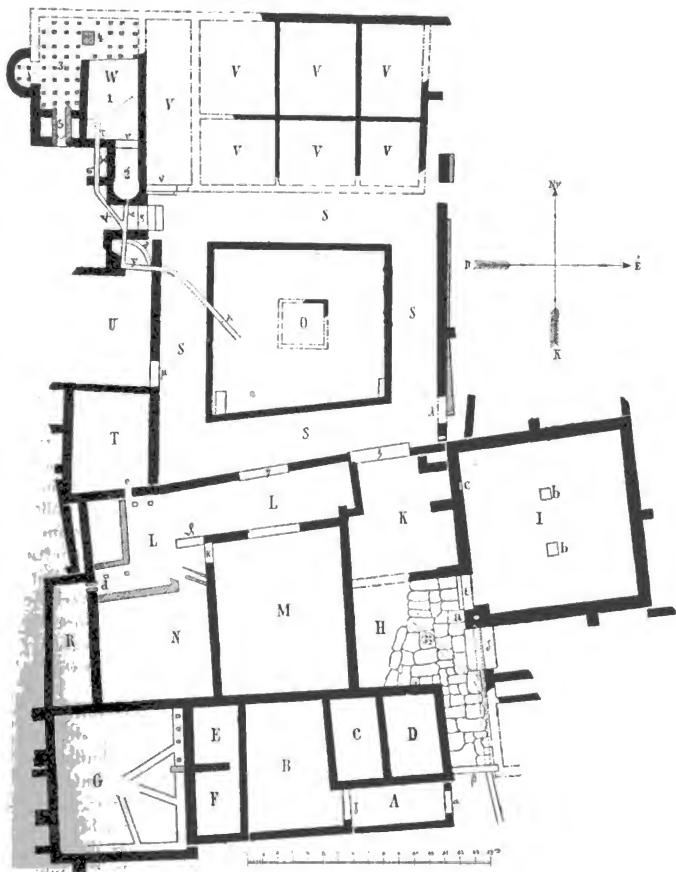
GRUNDRISS DES GROSSEN WOHNHAUSES.
